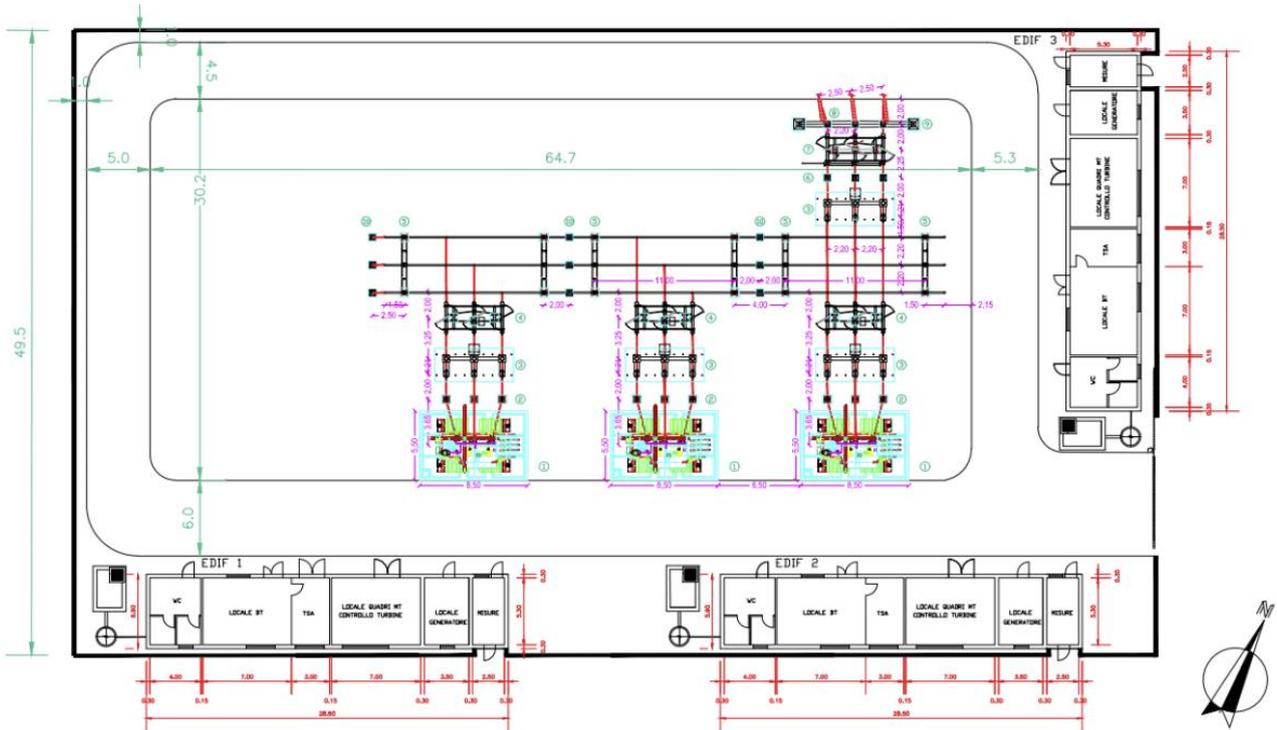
Layout stazione elettrica di utenza autorizzato con D.D. 114/18
